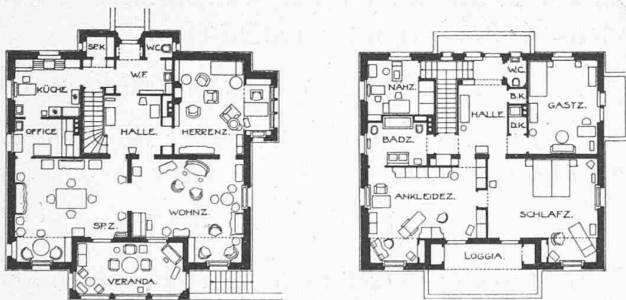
und 3. Grundrisse 1 : 400.
